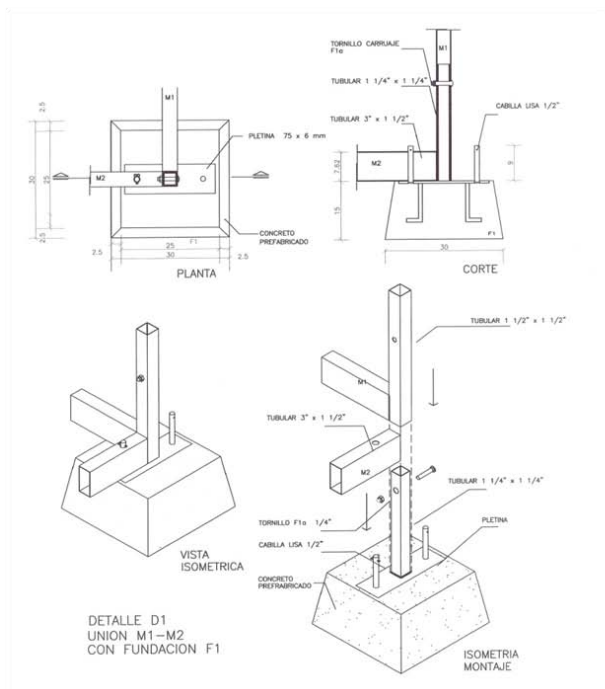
Detalle unión Fundación F1 y Marco M1. F: Ana Marrero
